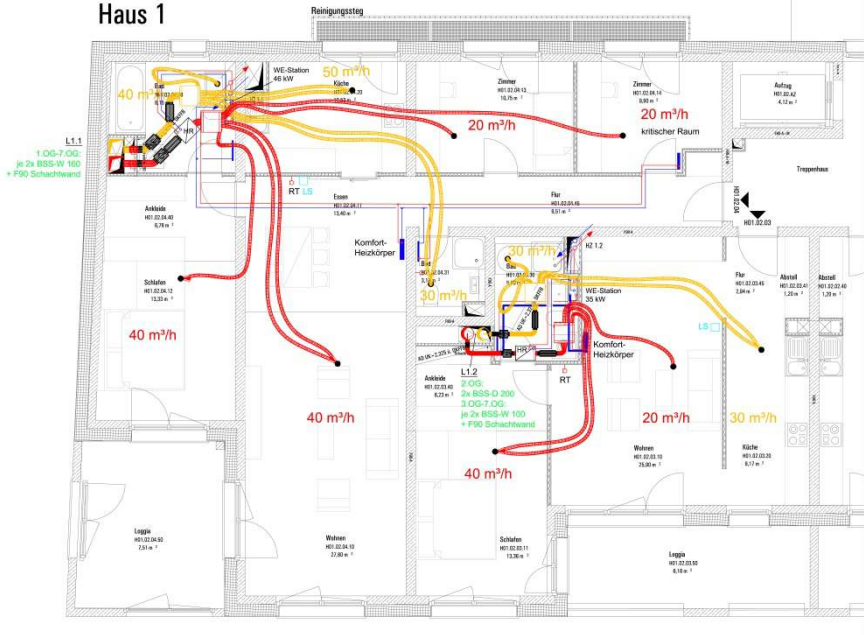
Planung Grundriss Wohnung 1 + 2 mit Decken-Lüftungsleitungen und Heizflächen
